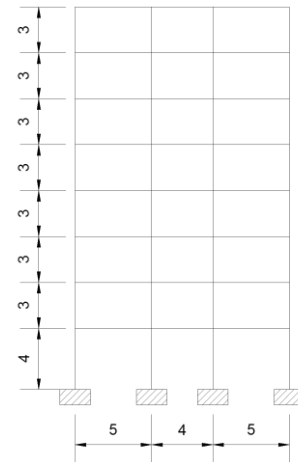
Elevación tipo de la estructura sentido corto (cotas en m)
